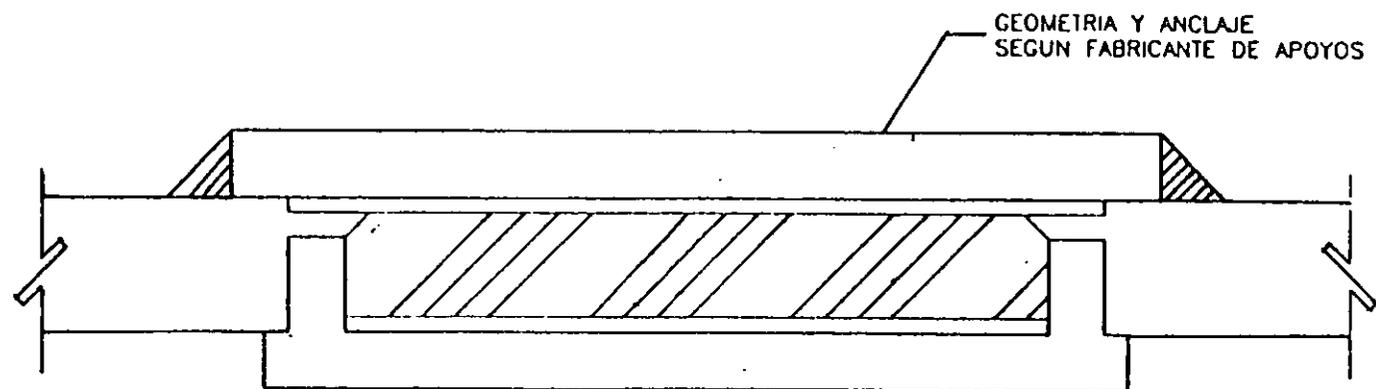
B. Apoyo de Neopreno Tipo Polvera (apoyo fijo).
